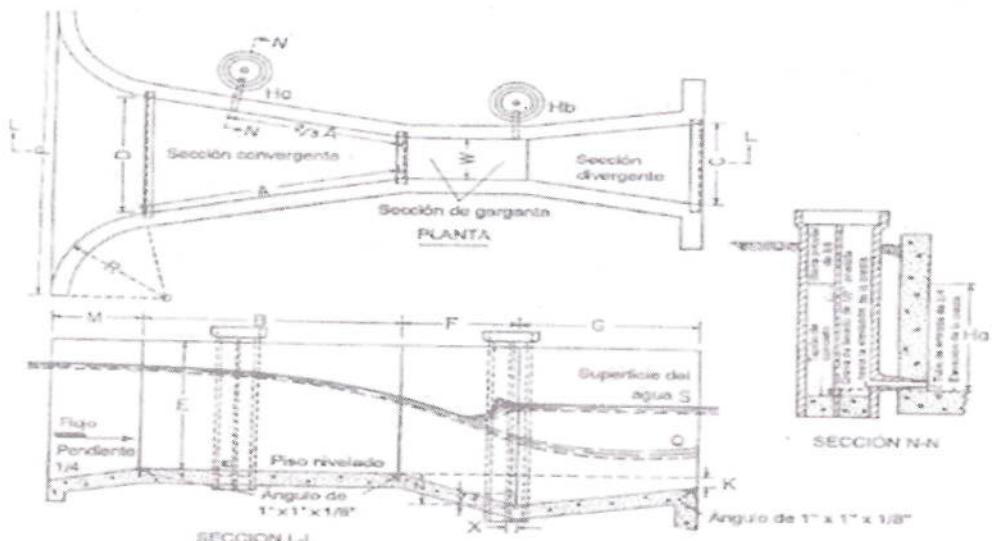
Planta, elevación y dimensiones de una canaleta Parshall.
